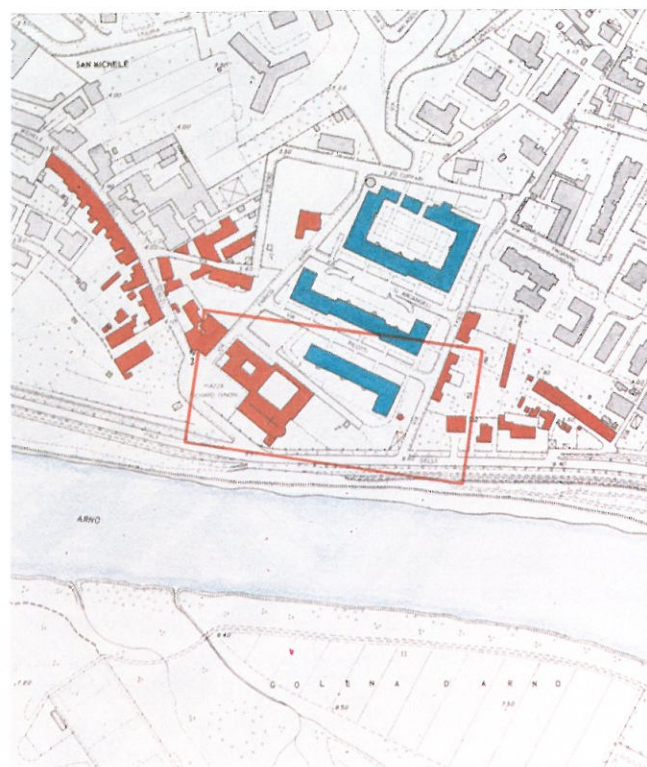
L'incontro del nuovo quartiere con S. Michele degli Scalzi.
